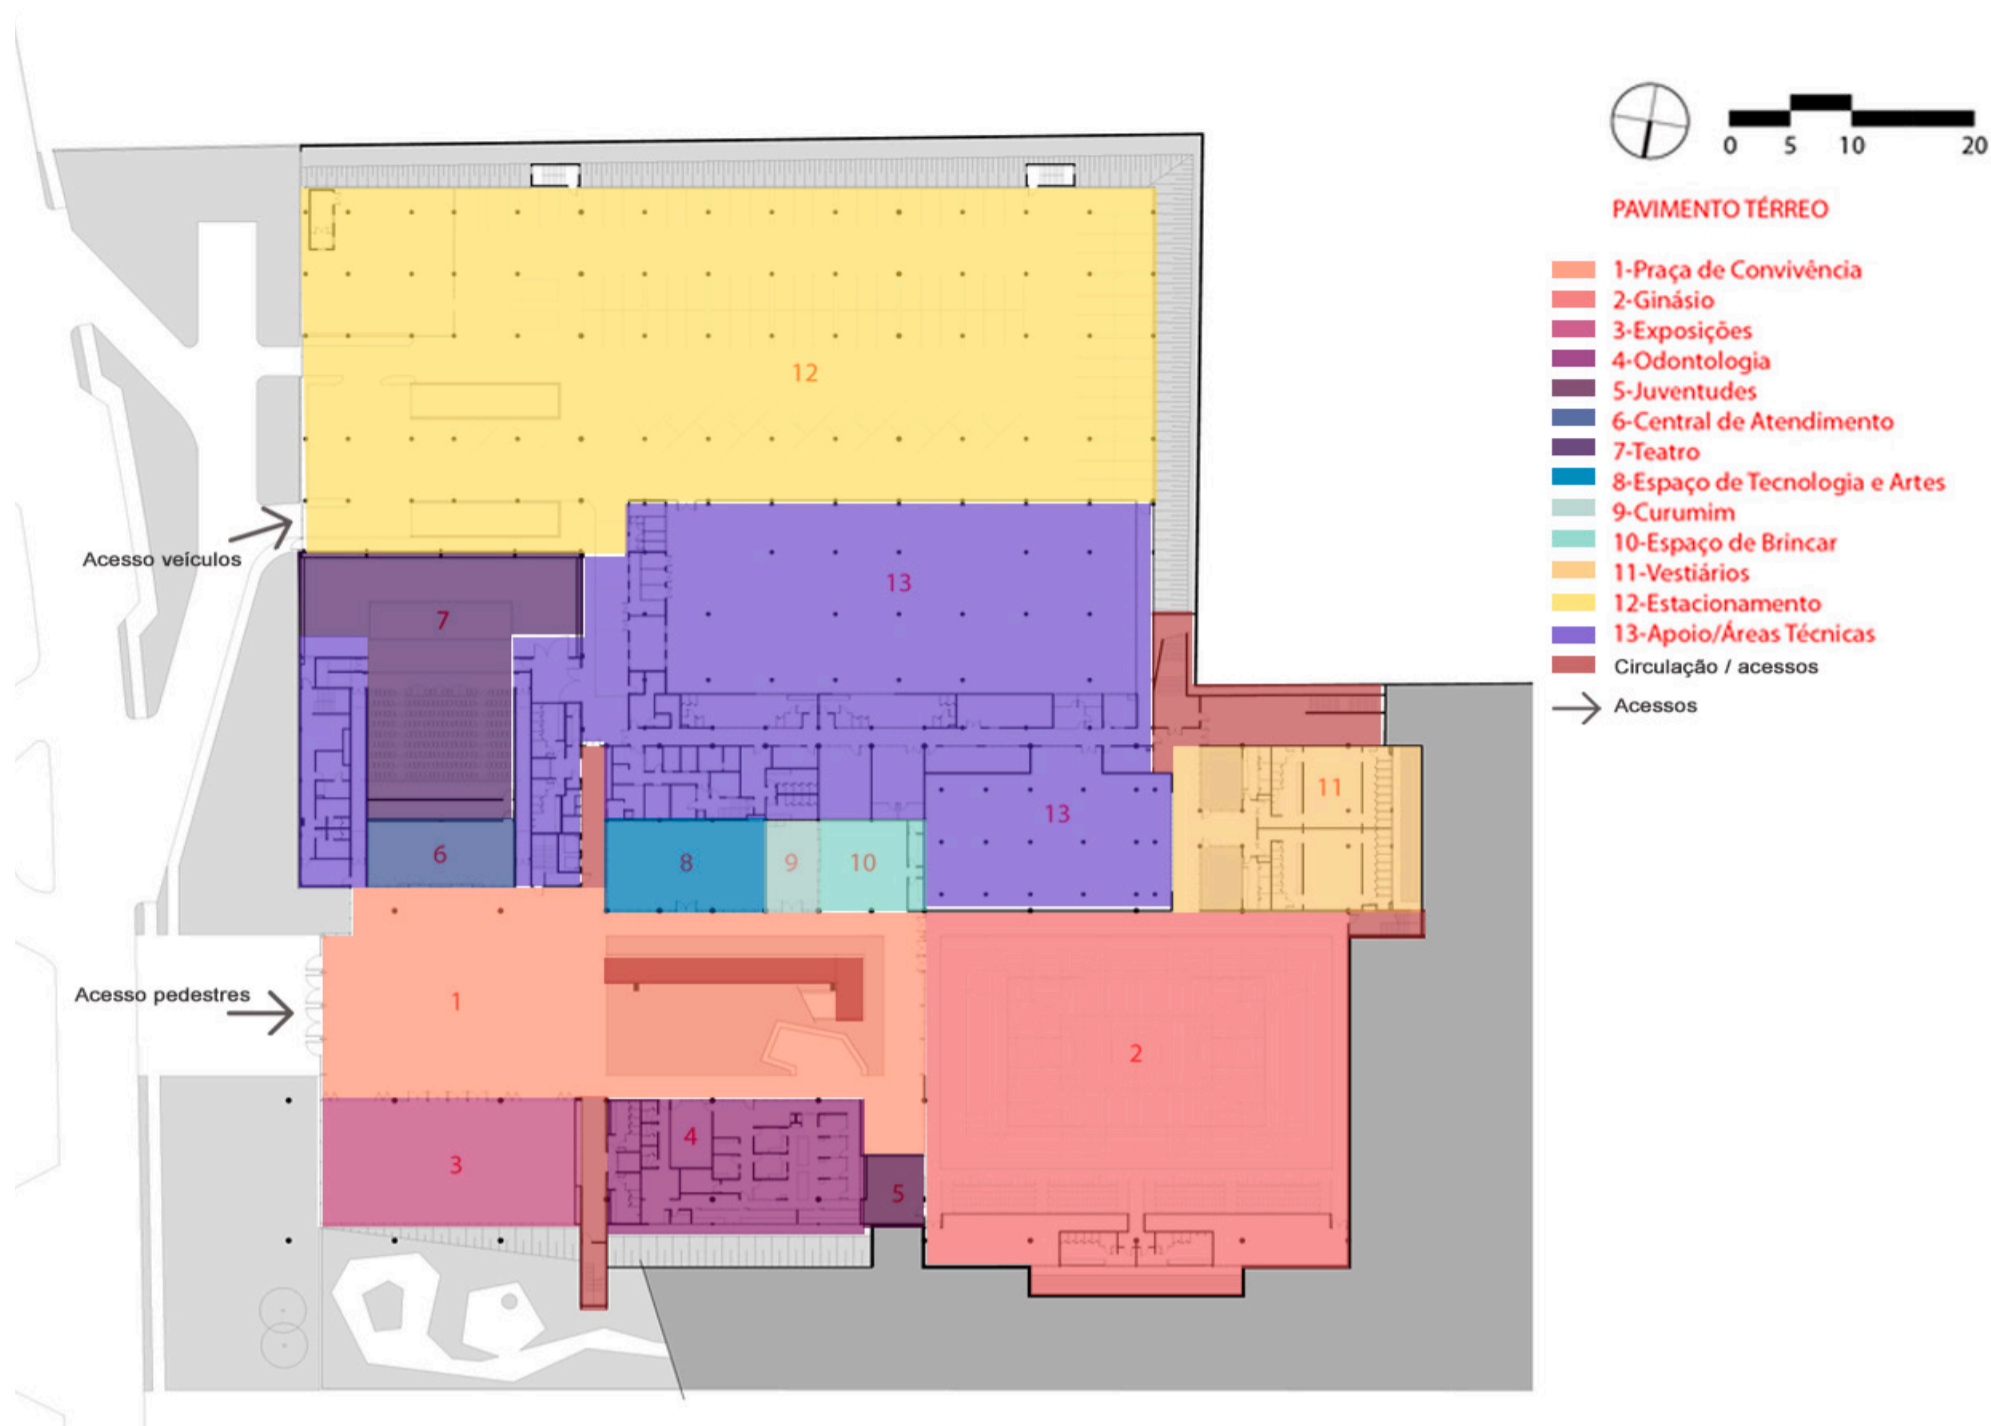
Planta térreo SESC Guarulhos. Fonte: Autora.
